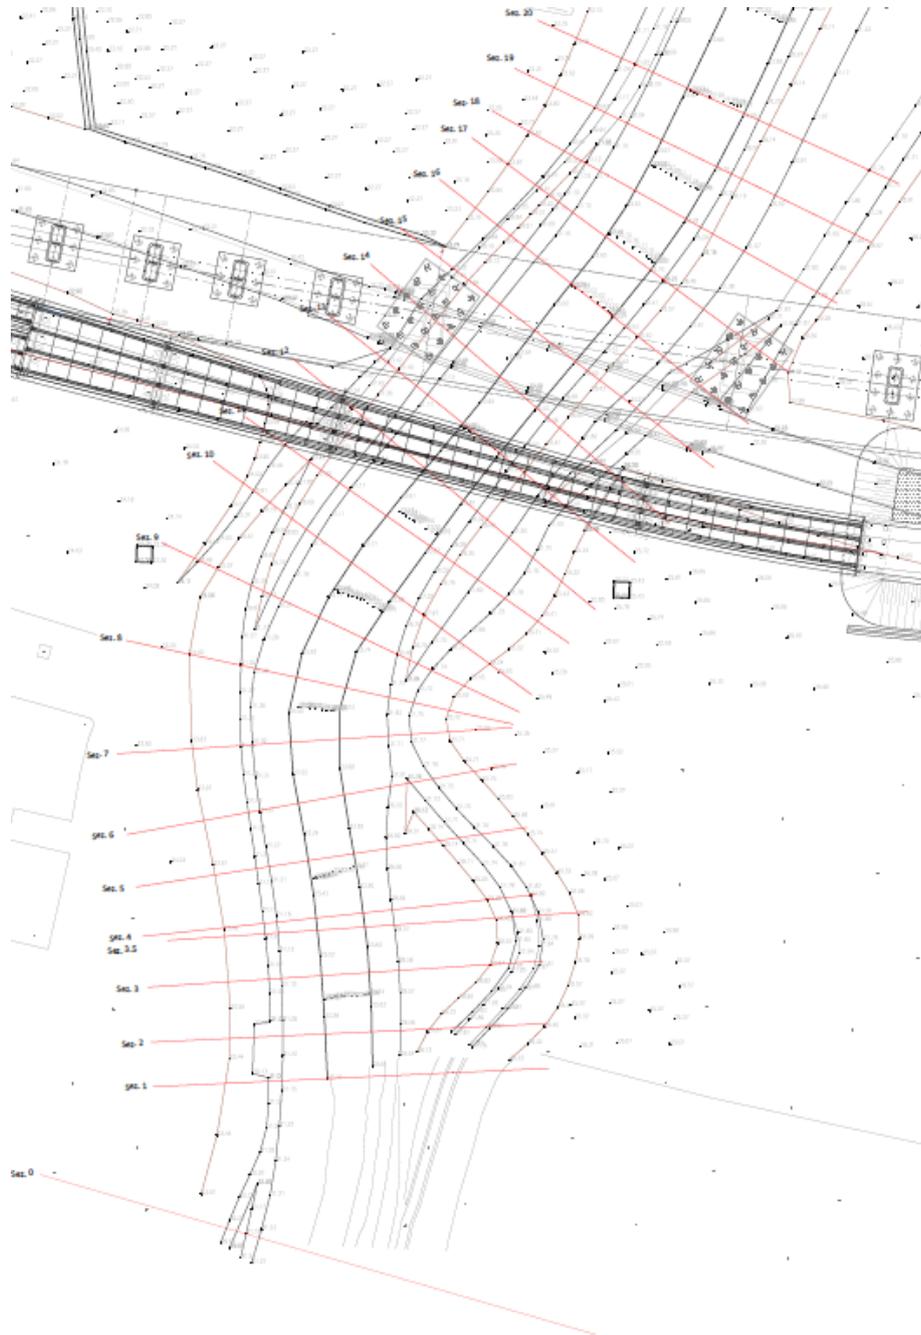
Torrente Alpone– Stralcio planimetrico stato di progetto con l'indicazione delle sezioni.
